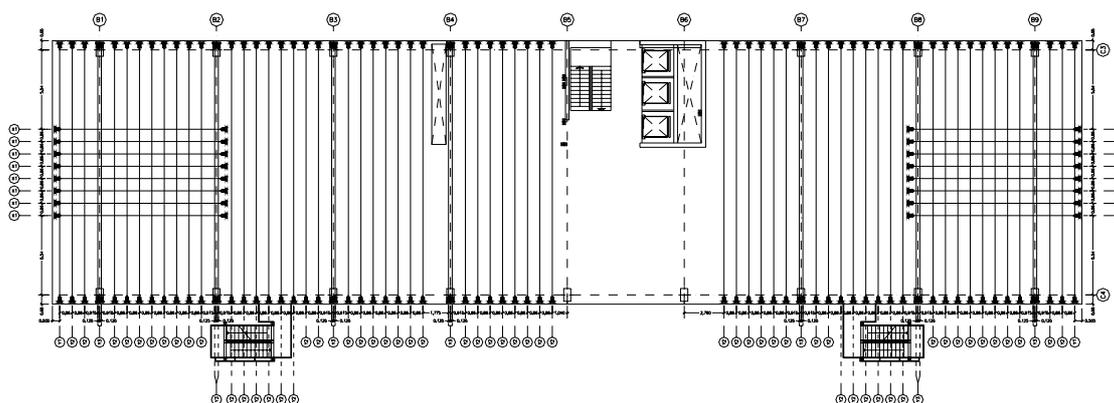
Distribución en planta de los tendones de pretensado en plantas tipo
